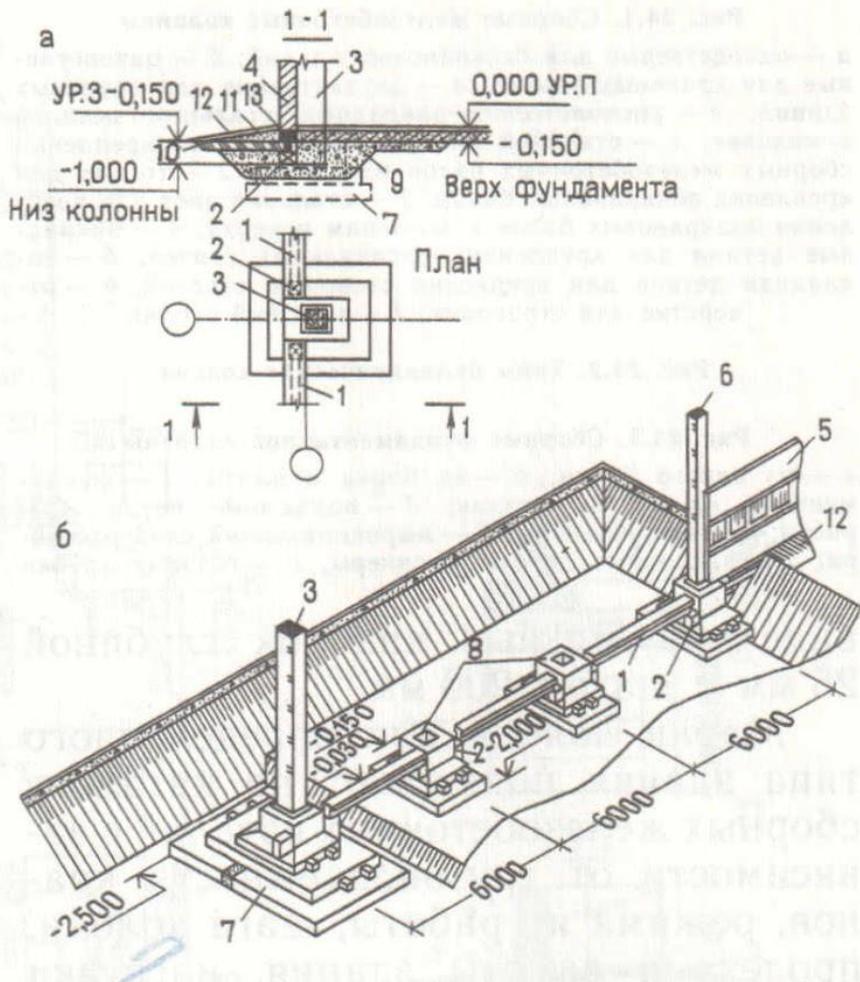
ОпираНИЕ фундаментных балок на фундаменты
